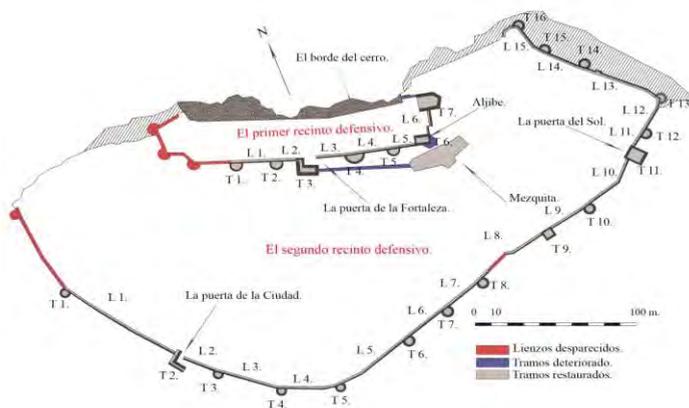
Planta de la ciudad fortificada de Archidona. Localización de las torres, murallas y puertas.
